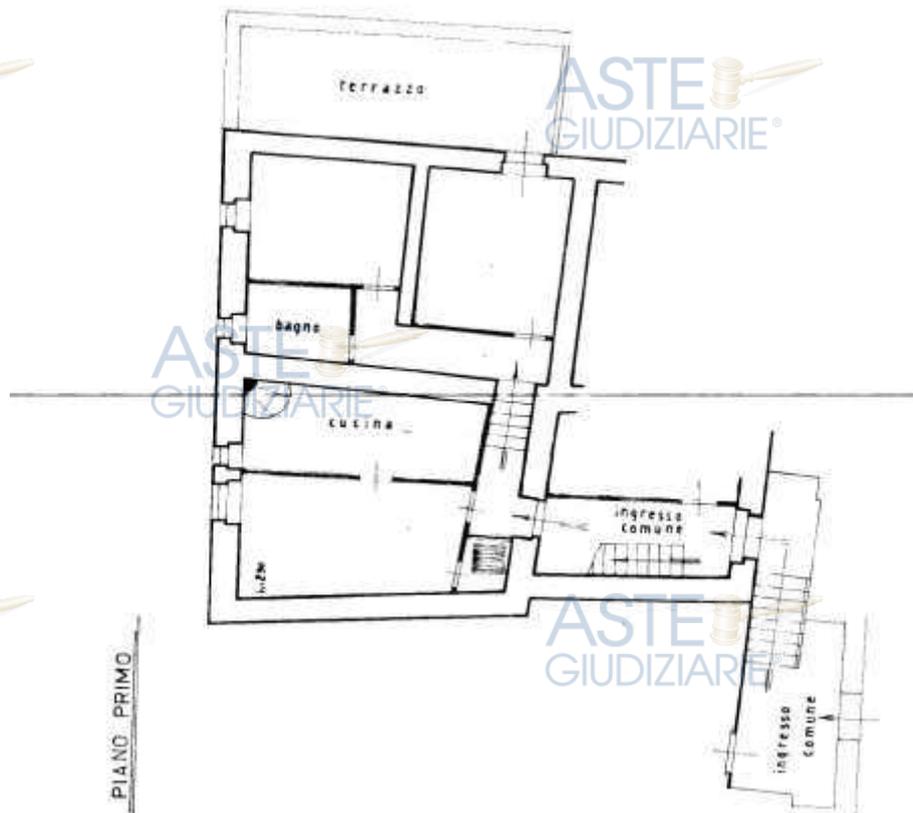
Planimetria particella 21 sub 1- Piano Primo
